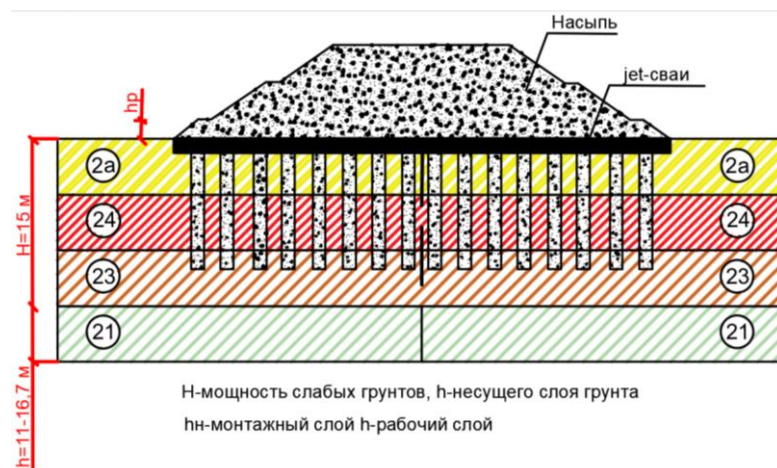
Устройство основания насыпи щебеночными сваями с жестким железобетонным ростверком
